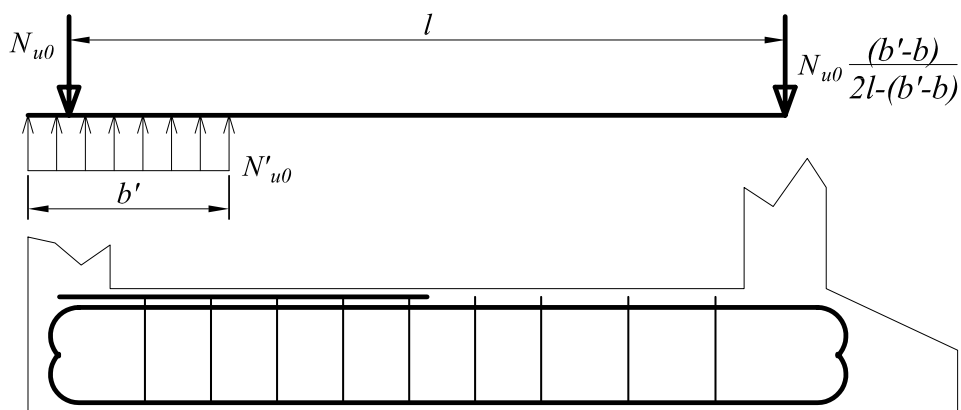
Chargement à prendre en compte pour le calcul d'une poutre de redressement (longrine) et allure du ferrailage à mettre en place.
